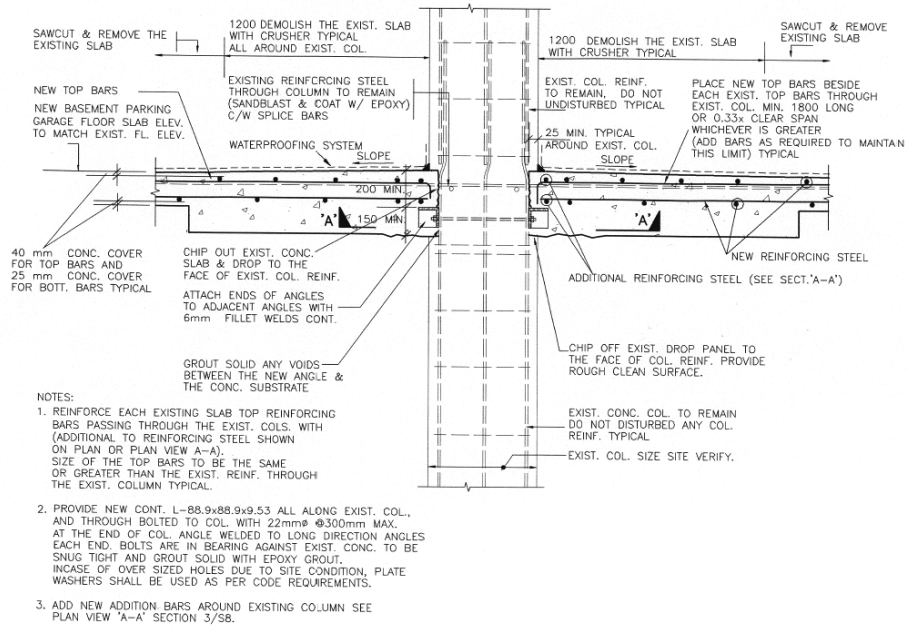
Imbinarea noului planșeu din beton armat cu stâlpul existent - secțiune tipică (reabilitare în ambele părți ale stâlpului)
